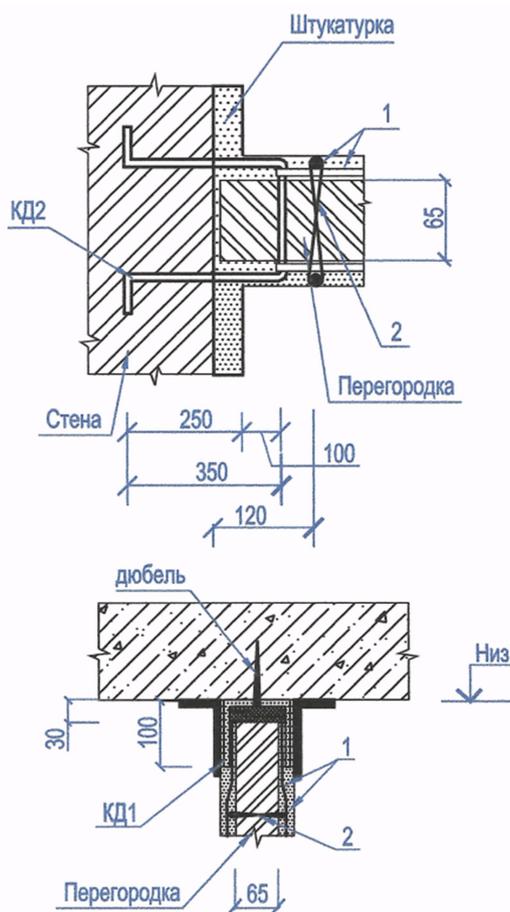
Узел крепления кирпичной перегородки к стене и плите перекрытия
